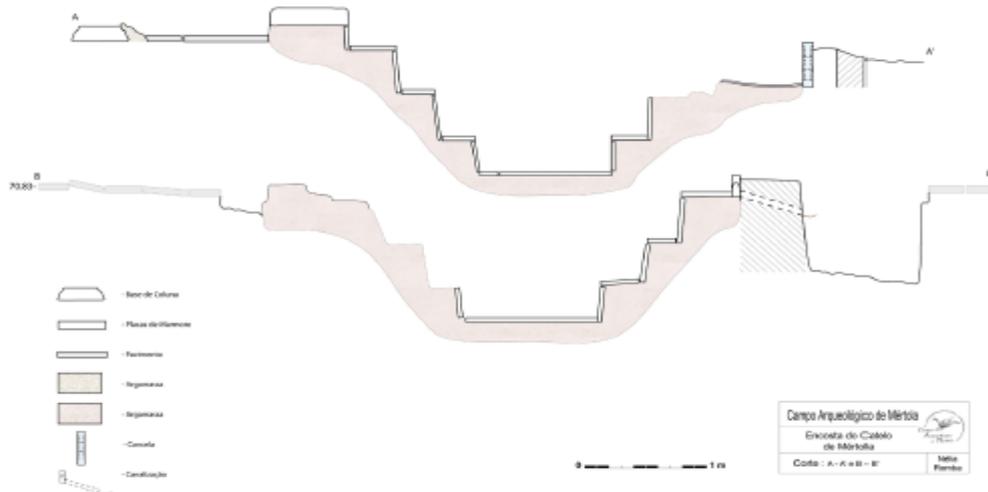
Planta das estruturas do batistério 1 de Mértola, Beja. (LOPES, 2015)
